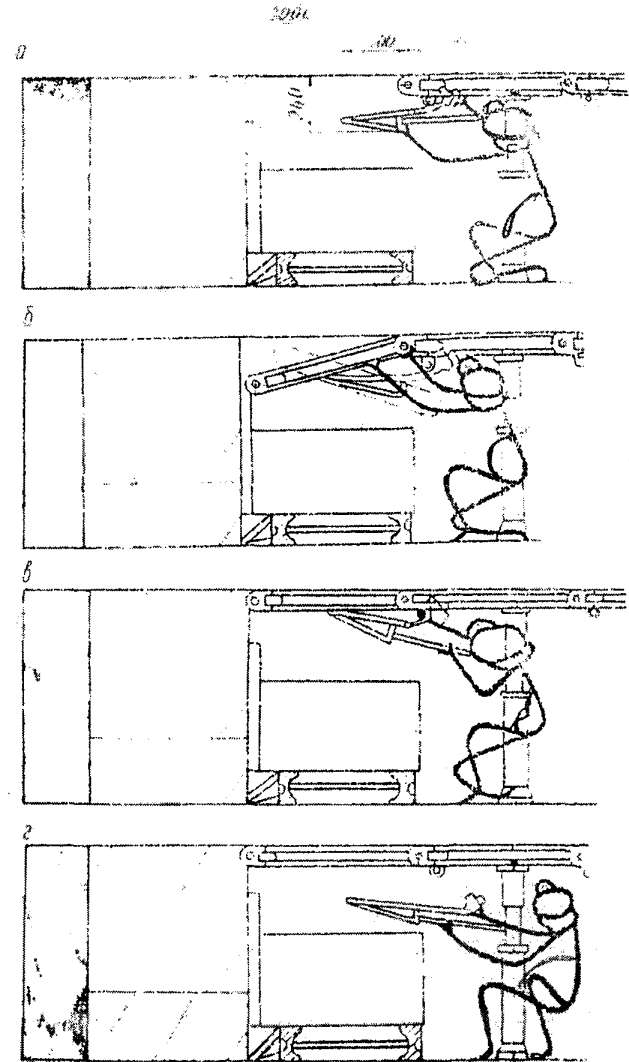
Схема навешивания верхняка типа IR20B
